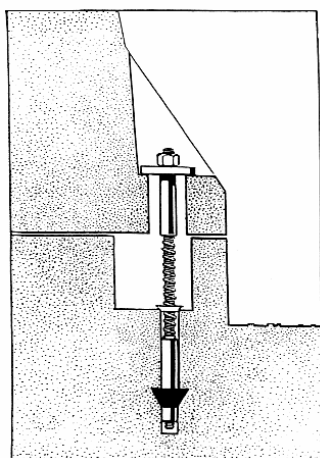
Particolare dell'ancoraggio duttile utilizzato nelle barriere da viadotto.
